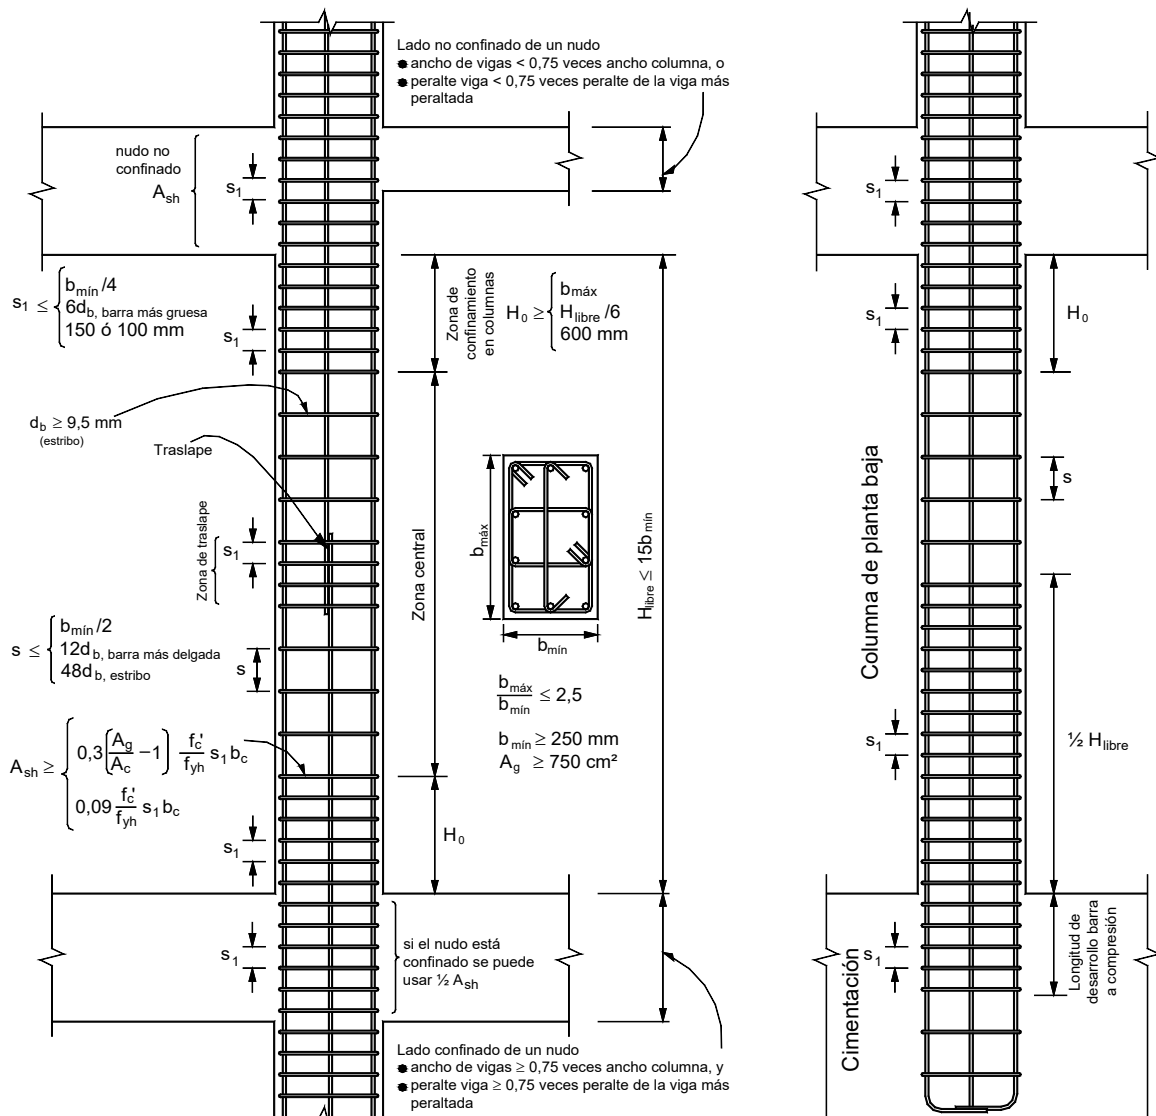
DETALLADO DE COLUMNAS EN MARCOS DÚCTILES (INDICATIVO)
